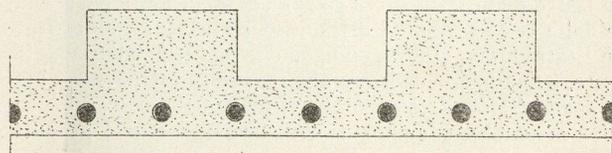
Tipo di armatura dissimetrica, sistema Sanders.
